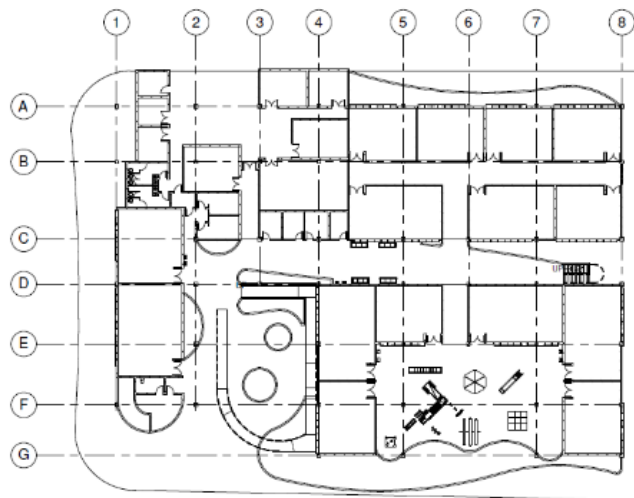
Imagen de Planta baja de Centro Educativo de Inicial y Básico.
